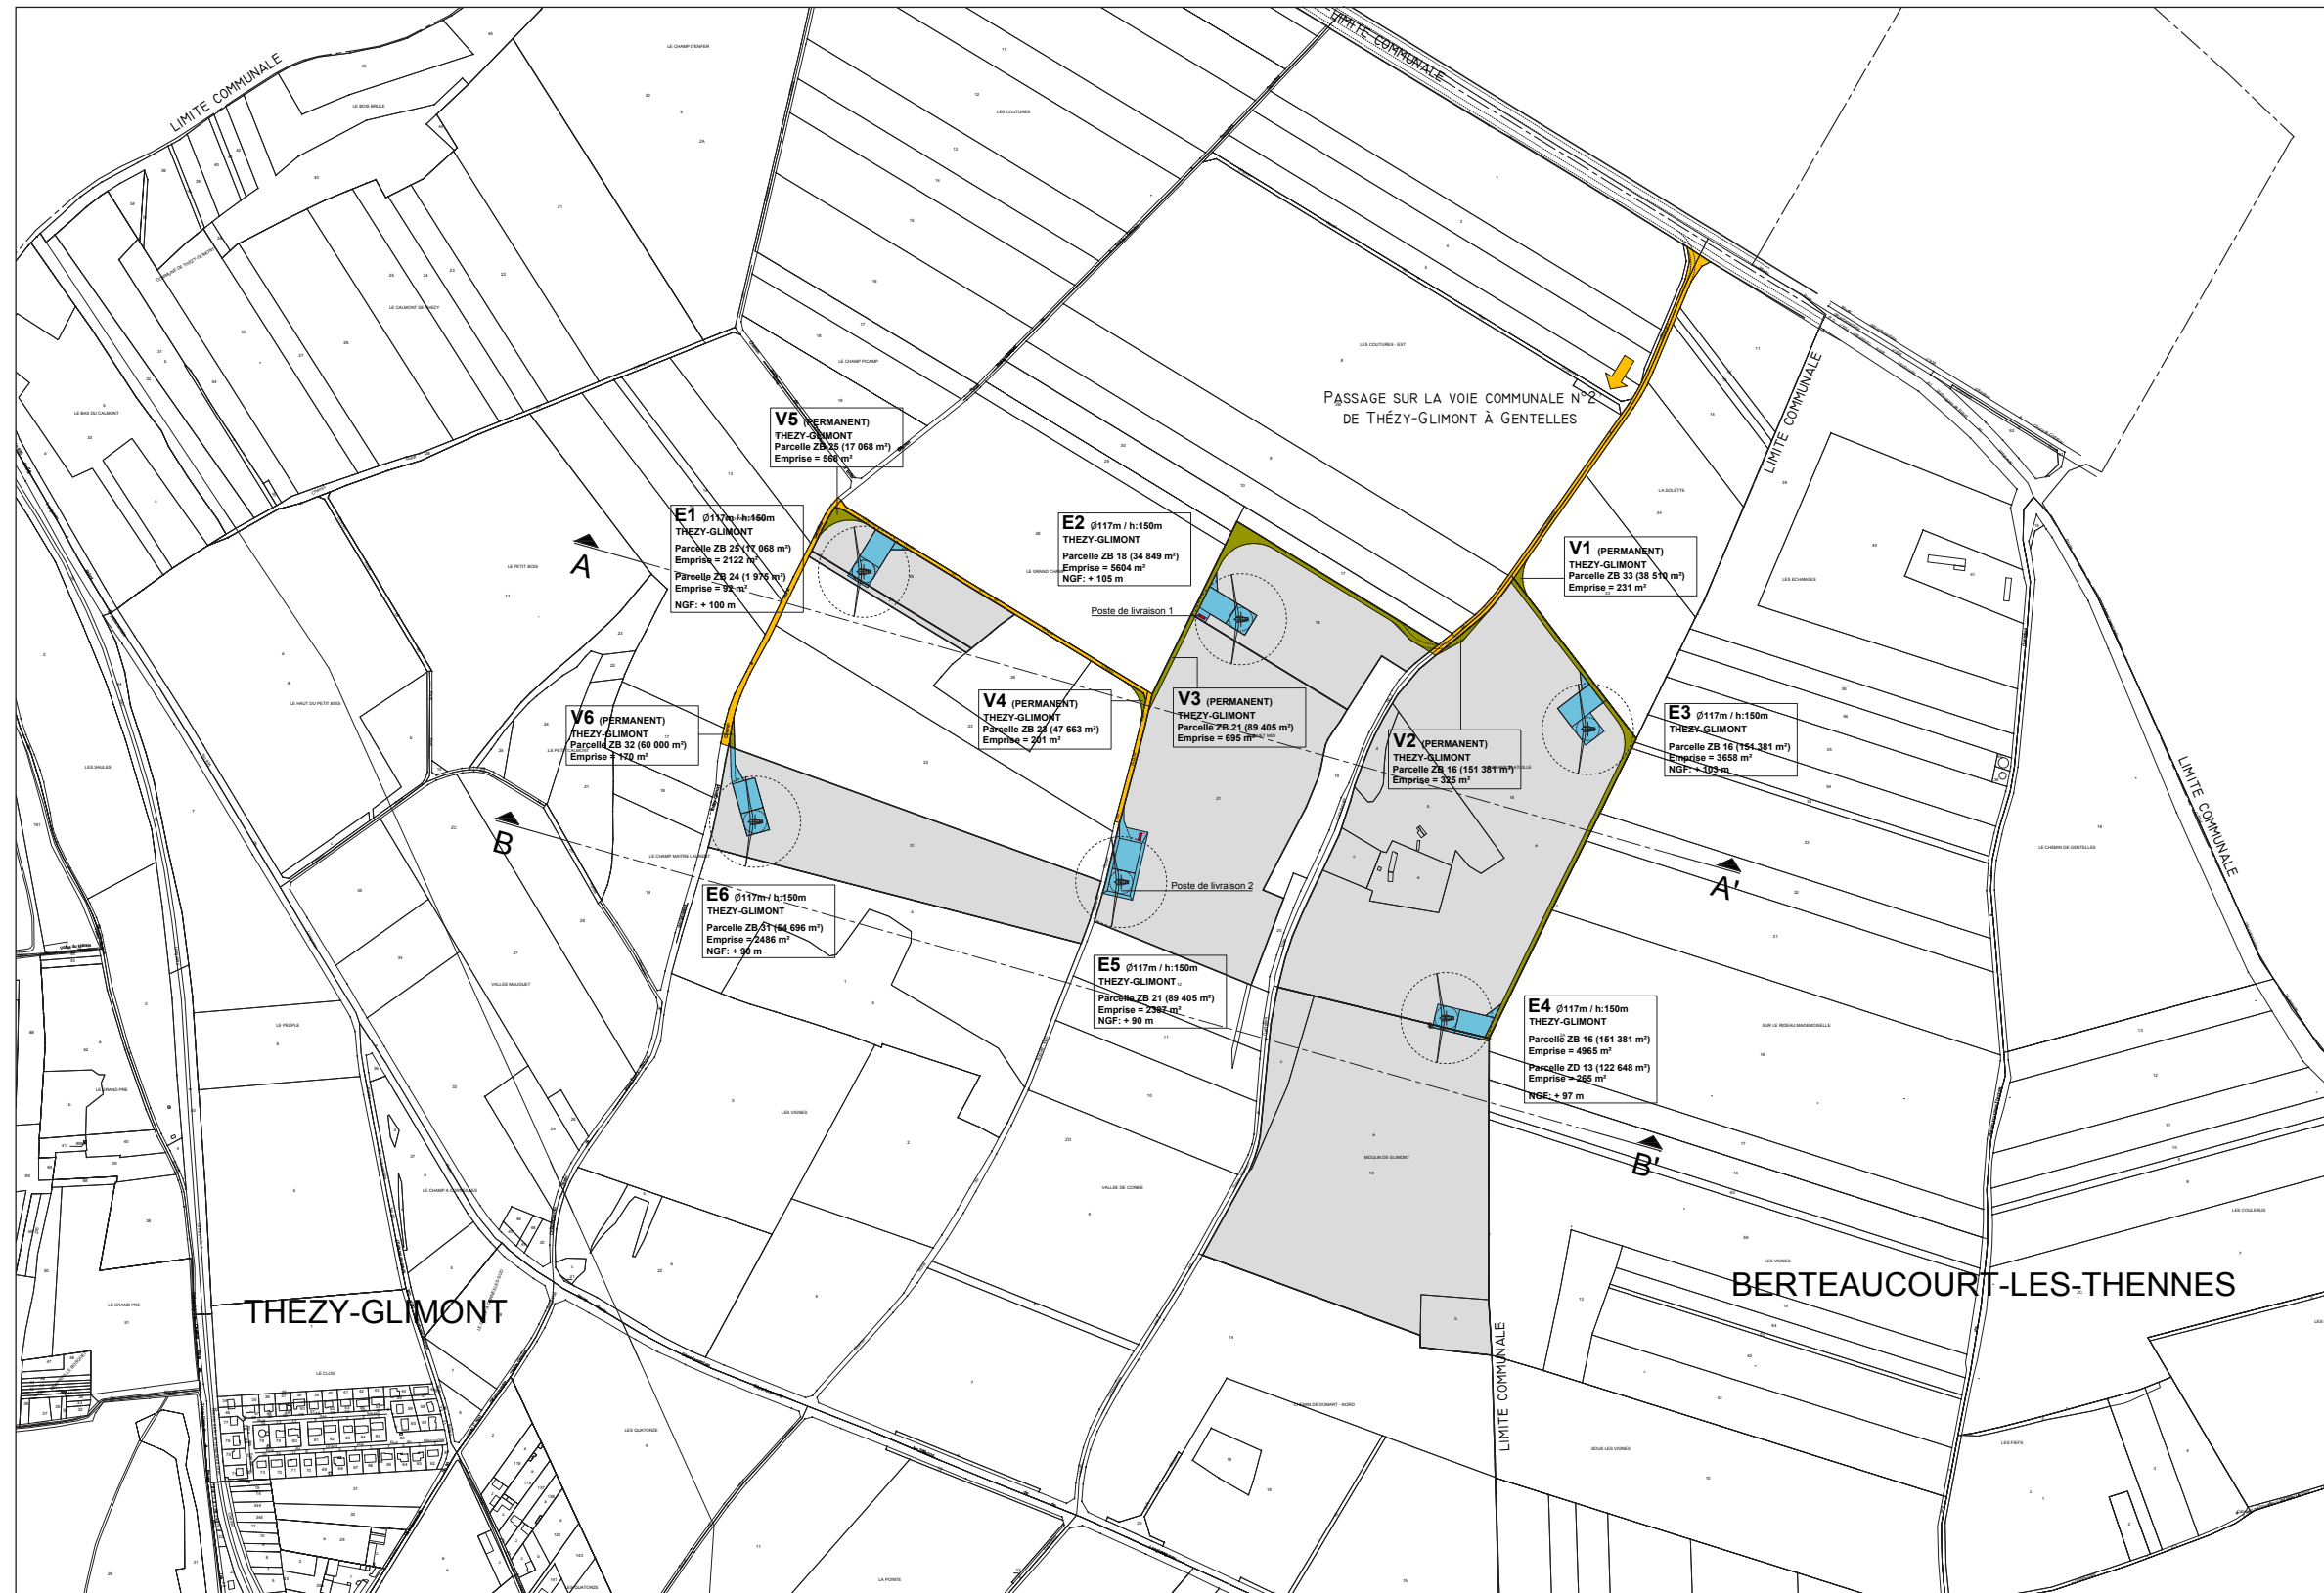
Plan général d'implantation cadastrale des éoliennes E1 à E6 / plan d'accès (hors échelle, source OZAS)
